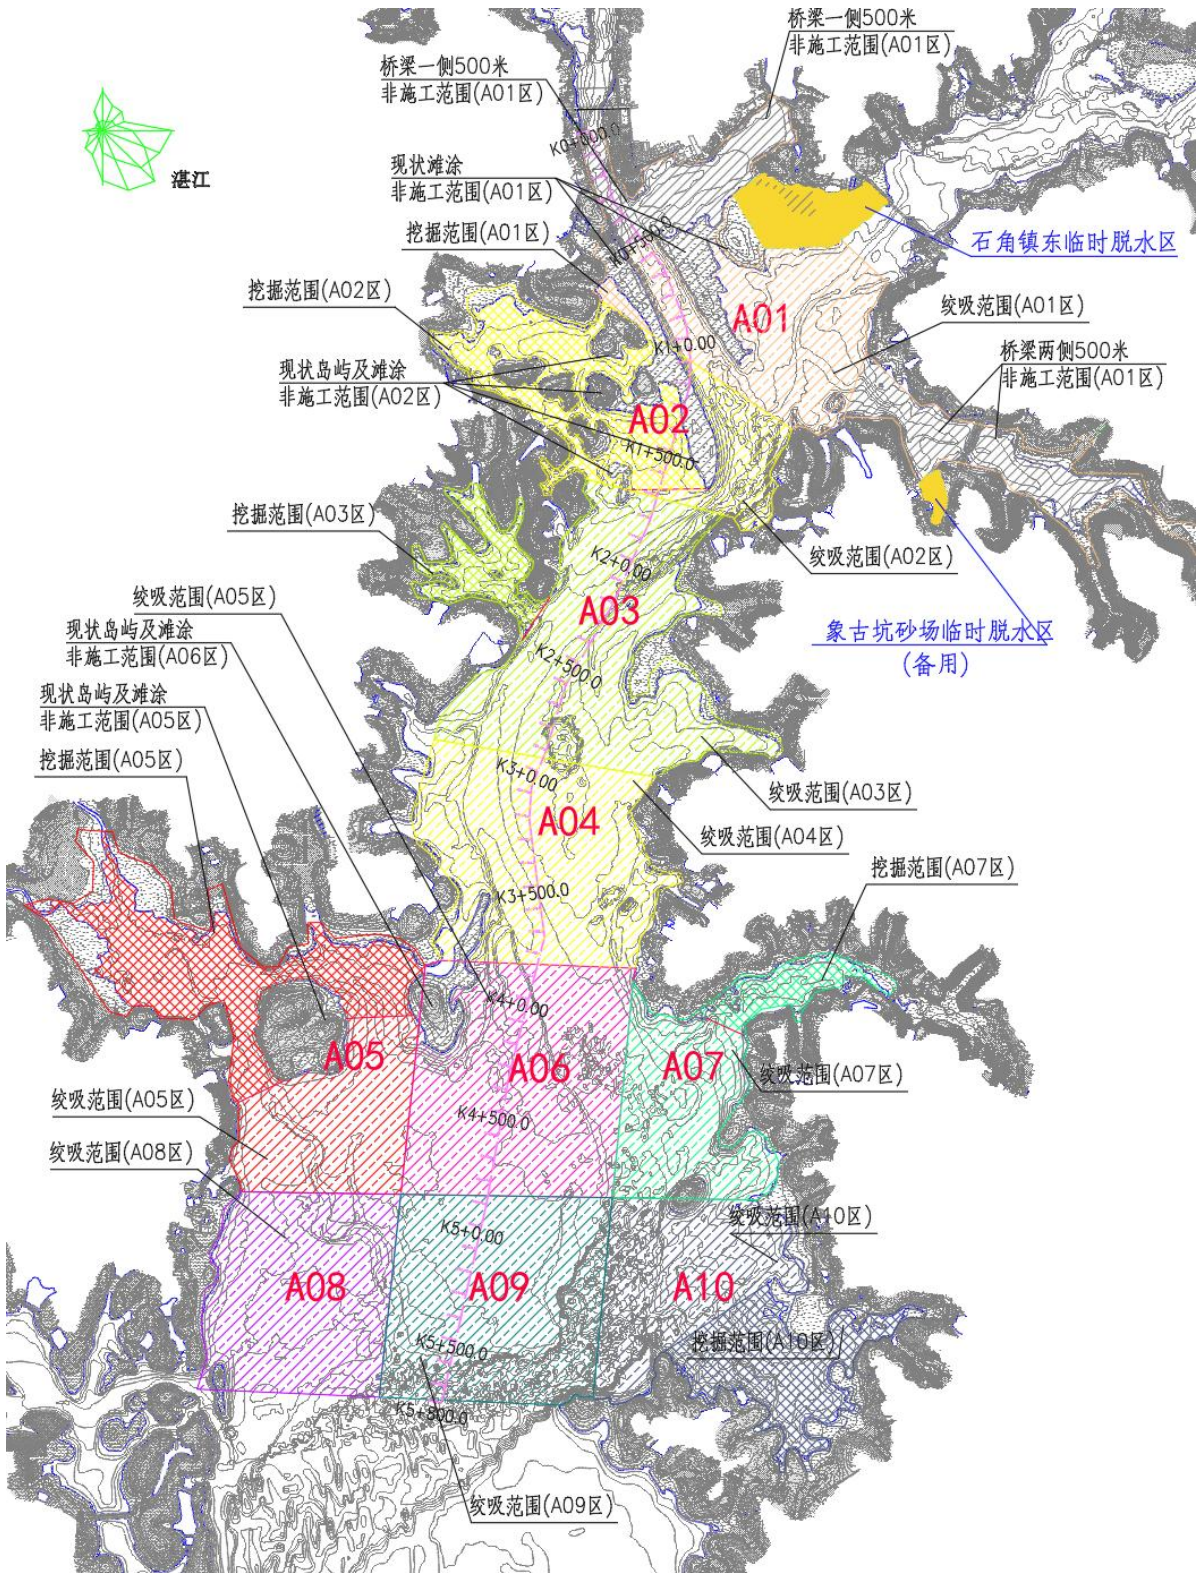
广东省鹤地水库库尾清淤平面布置图
